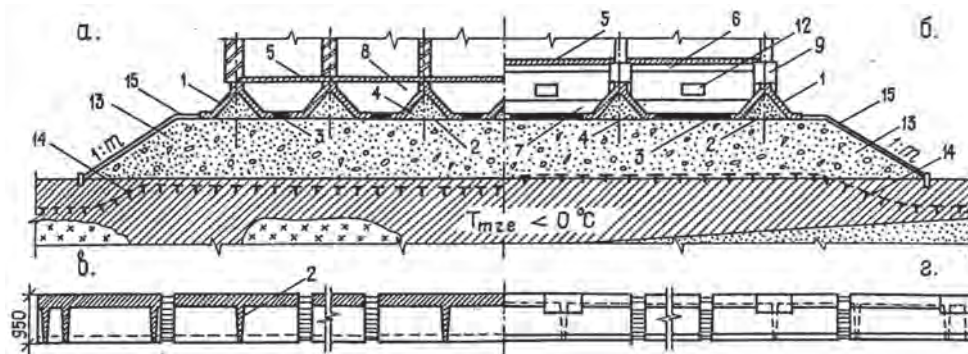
Схема строения фундамента-оболочки на мерзлых грунтах (рисунок из отчета Бердичевского Ю.В., Гончарова Ю. М.) [1].
